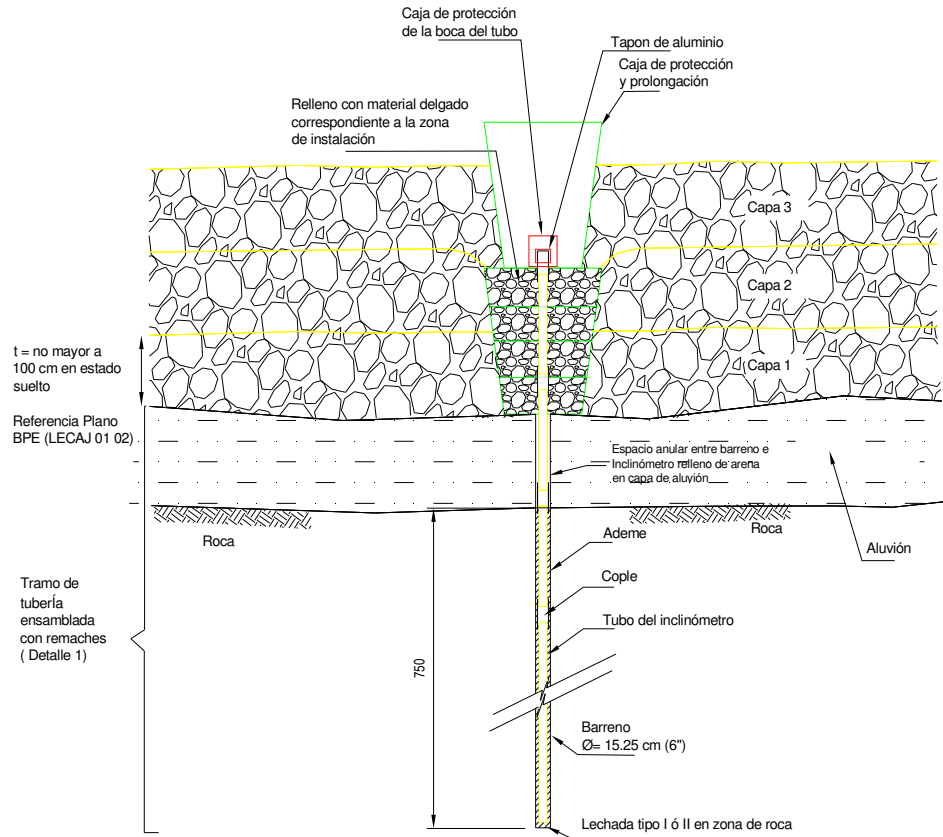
Instalación del tubo de arranque del inclinómetro y caja de protección para prolongar la tubería.
